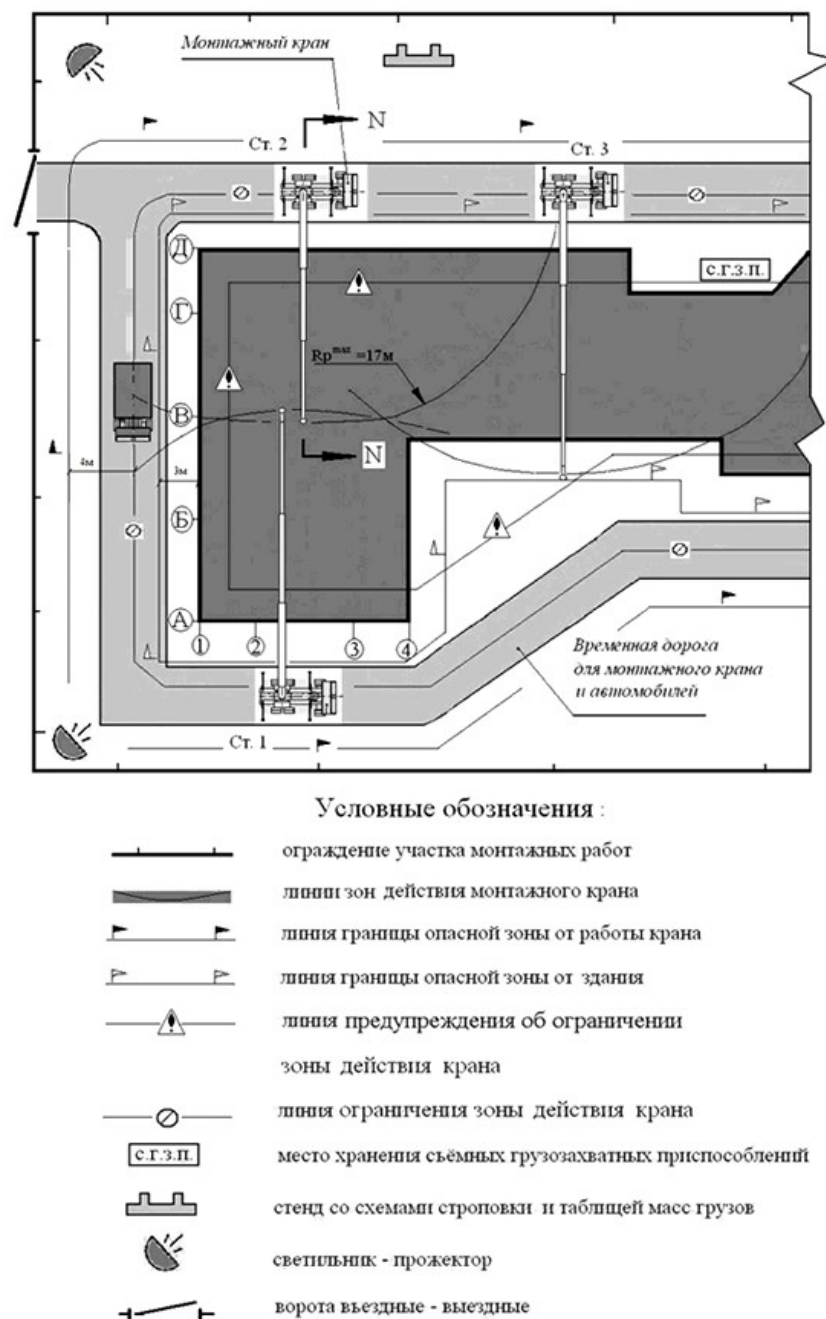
Схема горизонтальной привязки монтажного крана (фрагмент)
